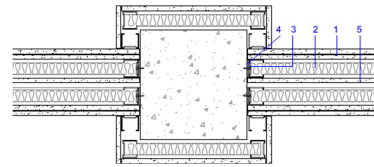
Encuentro de Tabique de entramado autoportante con pilar
